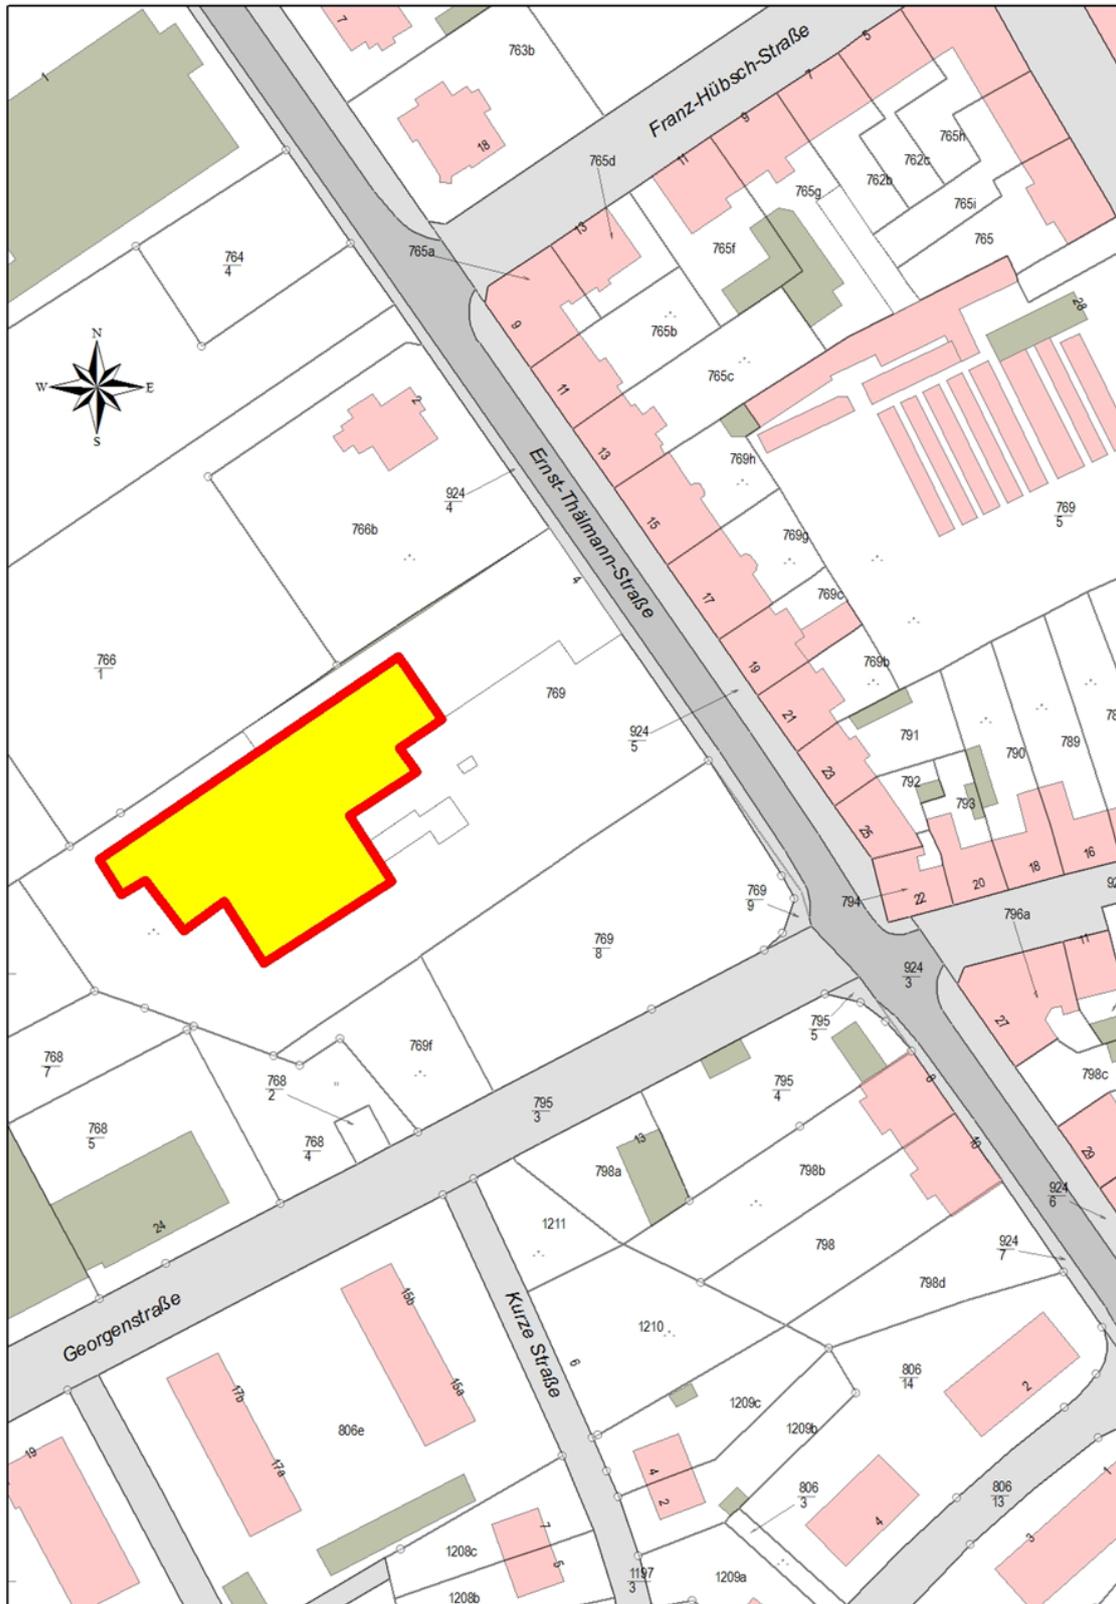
Lageplan Ernst-Thälmann-Straße 4 – GIS Freistaat Sachsen
